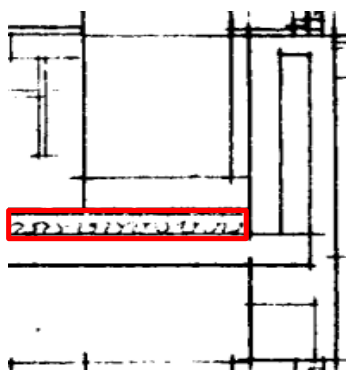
Tagopbygning og loftsopbygning (type K8) bestående af massiv beton isoleret med lecabeton
